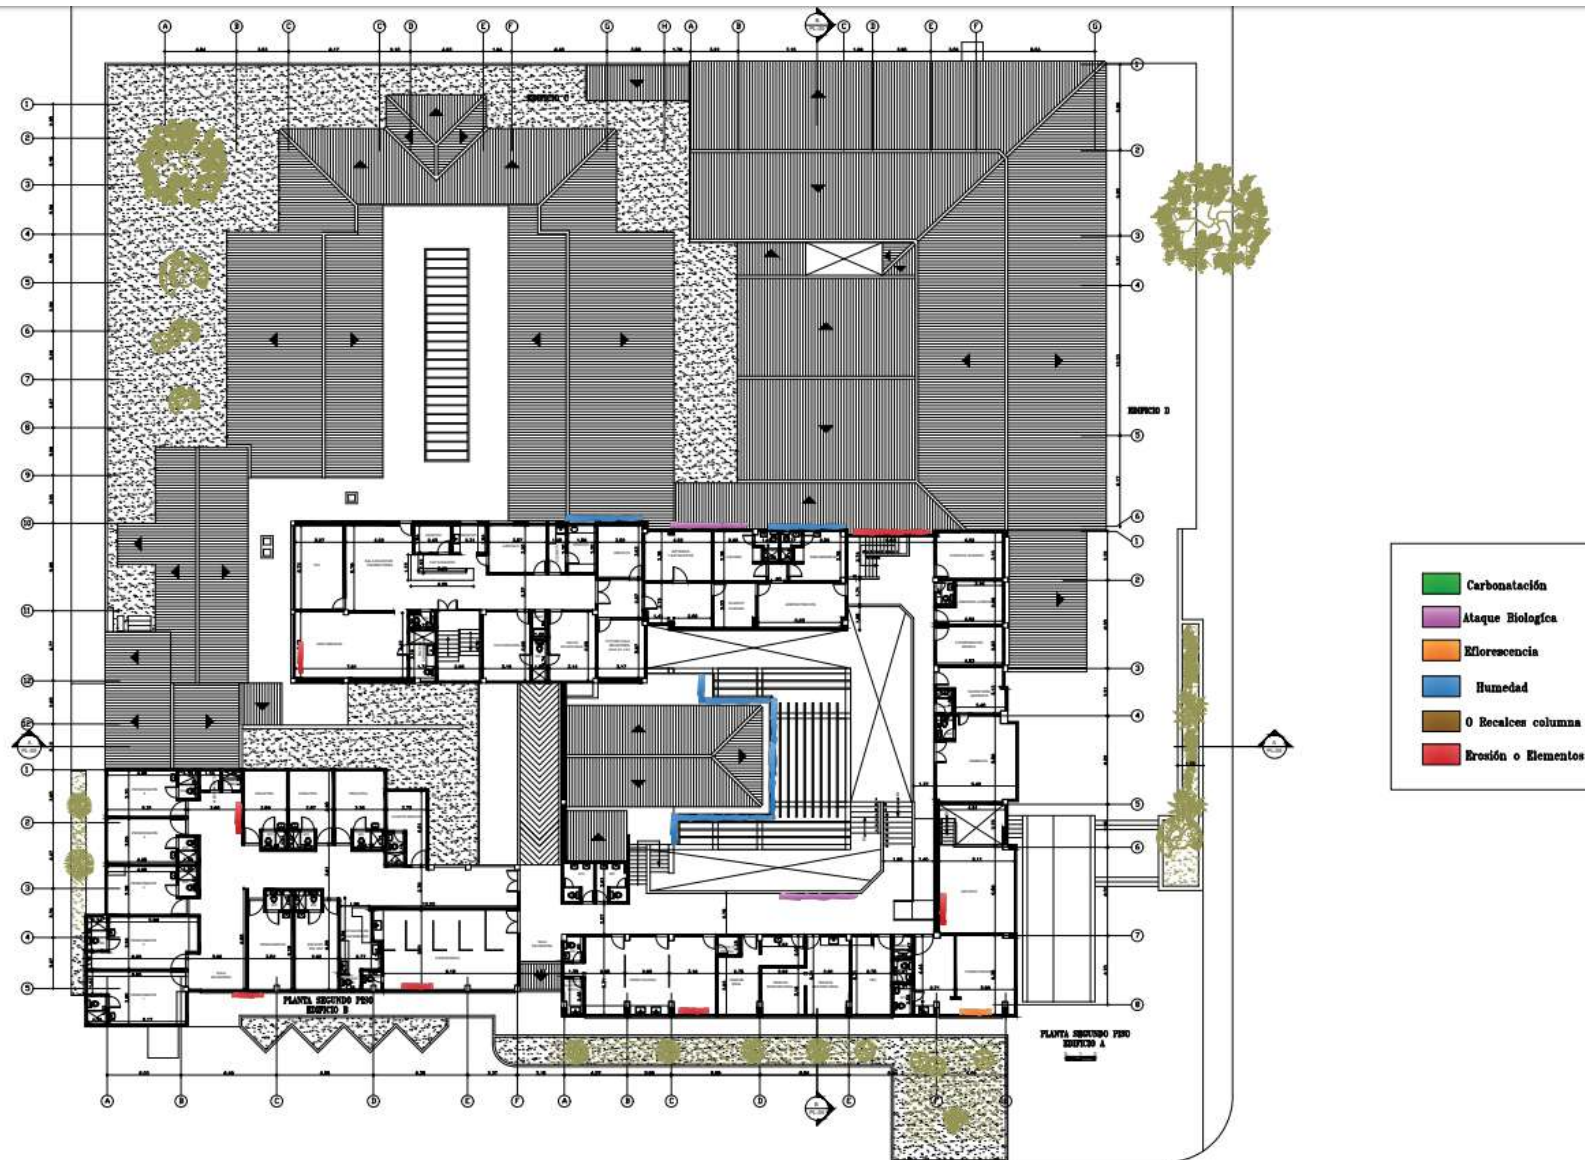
Plano 1 Plano de Calificación Planta Primer Piso. Fuente: Elaboracion propia
